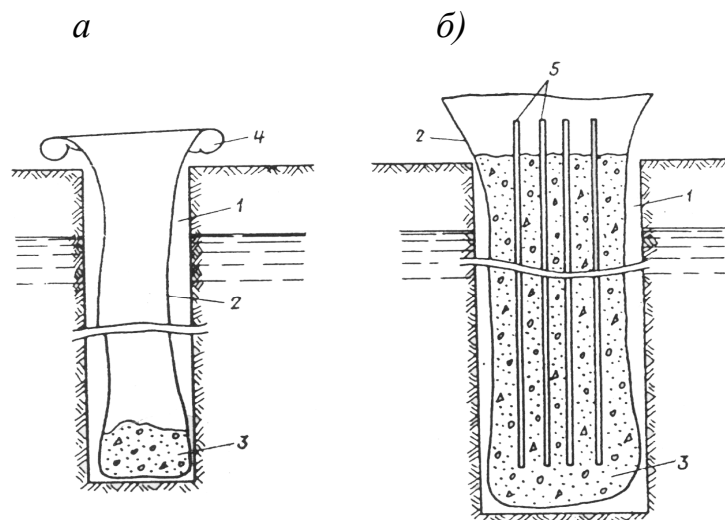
Улаштування набивних паль із гнучкою захисною оболонкою: а – бетонна паля; б – залізобетонна паля
